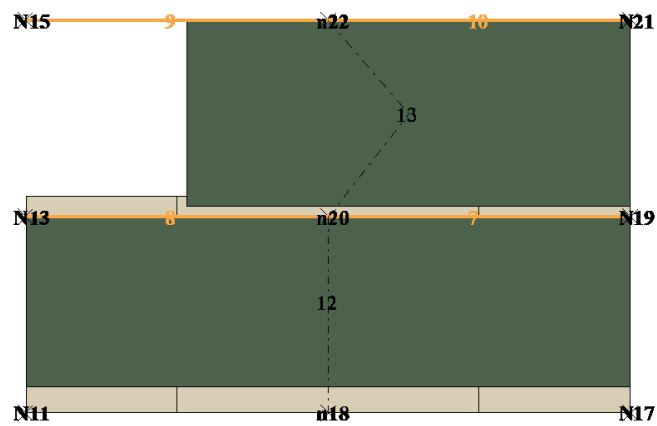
Prospetto Parete 3 - Modello Isolato
